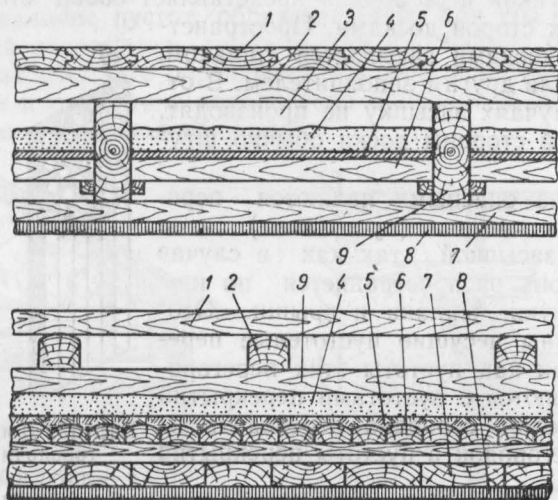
Балочное междуэтажное перекрытие, имеющее лаги:
